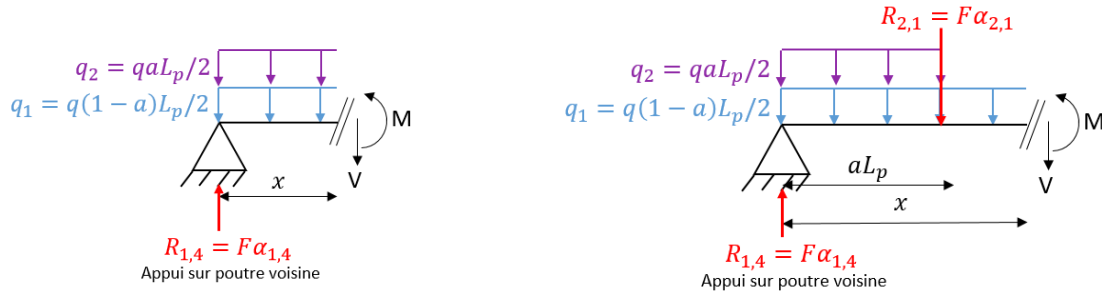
Poutre type 1 - coupe 1 (gauche) et coupe 2 (droite)
